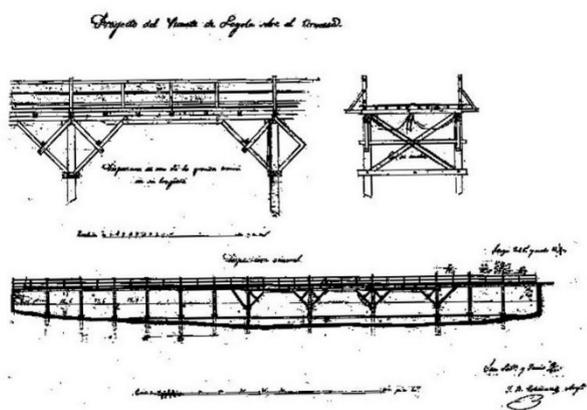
Planos del puente de madera construido en 1840. Fuente: Elejalde Aldama F., Behin Batean Loiolan. Pasado, presente y futuro de Loiola. <http://loiola.weebly.com/6---los-puentes.html>
